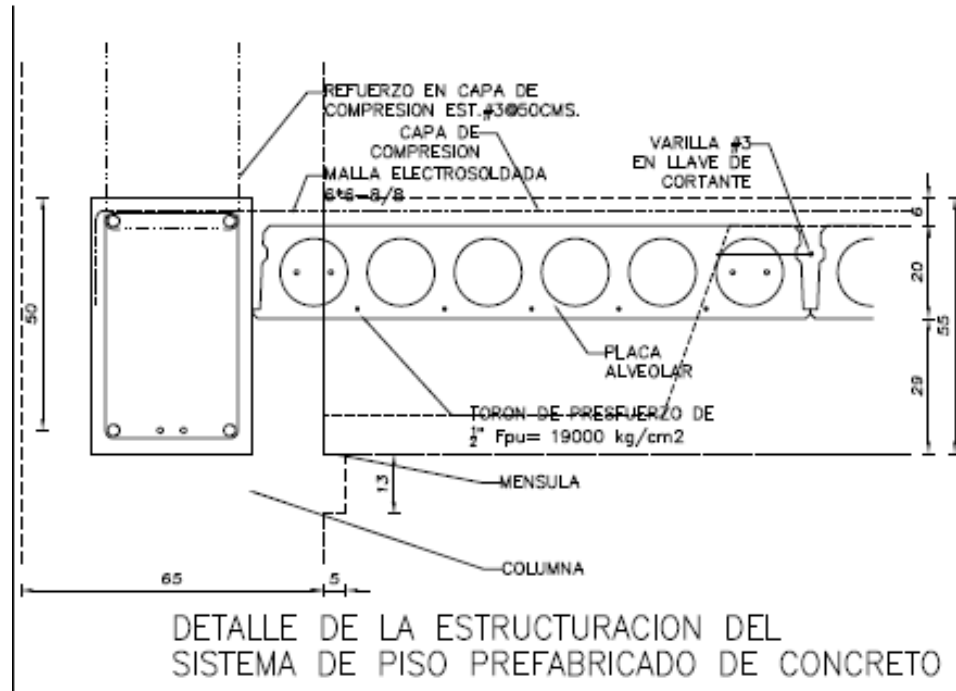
Detalle de refuerzo en sistema de piso prefabricado del prototipo base fija
